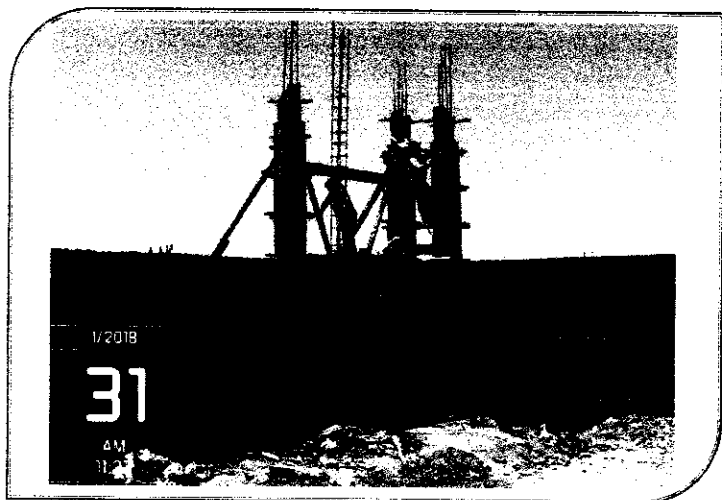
Se realizó el encofrado de columnas 30x30 de tanque elevado con acero 401/2" y estribos de 3/8", concreto f'c=280Kg/m2.
